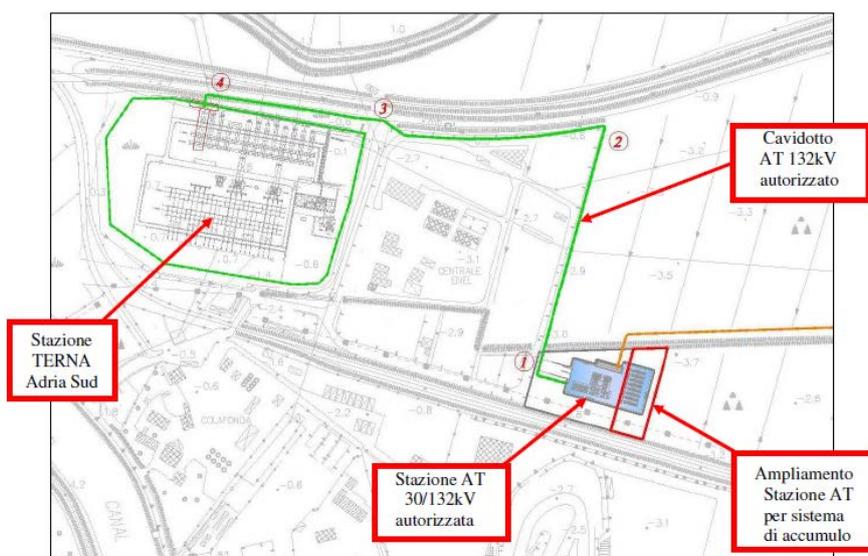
/69 – Stazione utente e del cavidotto AT 132kV di collegamento alla RTN
